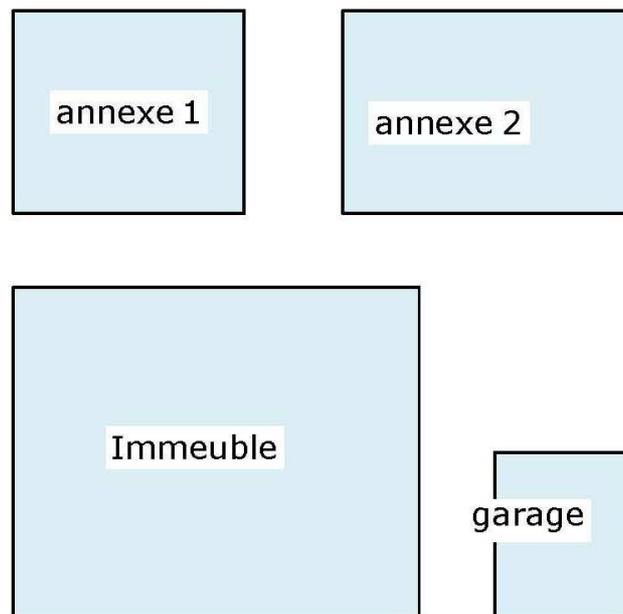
Exemple d'un bâtiment de forme complexe se composant de sous-structures indépendantes
